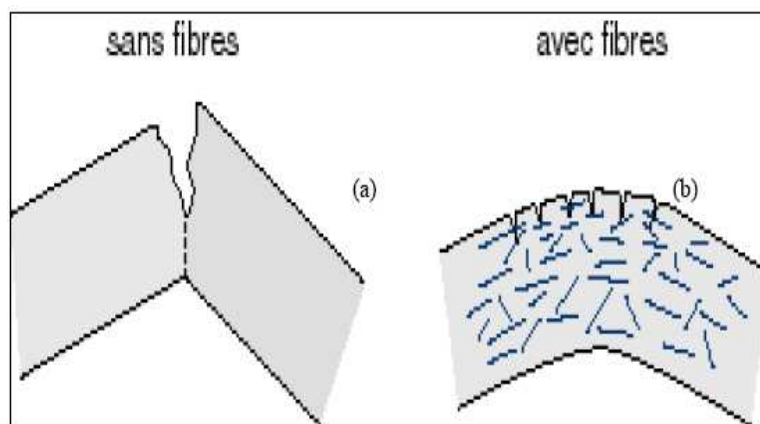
La fissuration dans le béton non armé de fibres (a) et béton armé de fibres (b)
